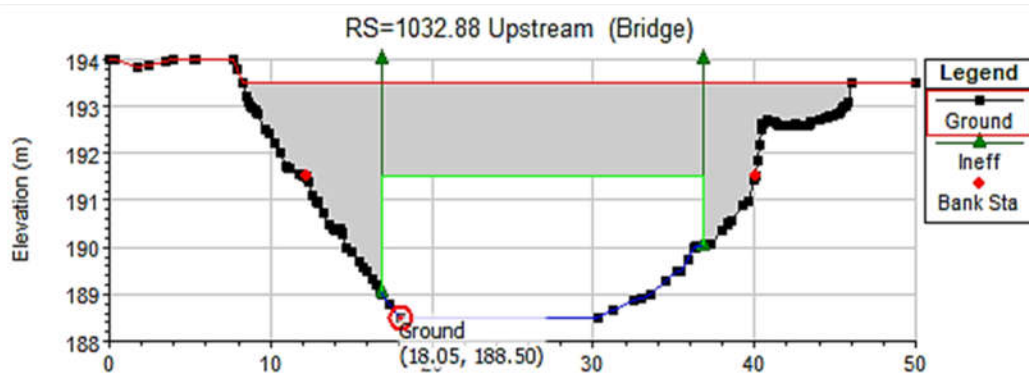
Sección aguas arriba del puente. Cota de fondo: 188.50 m
